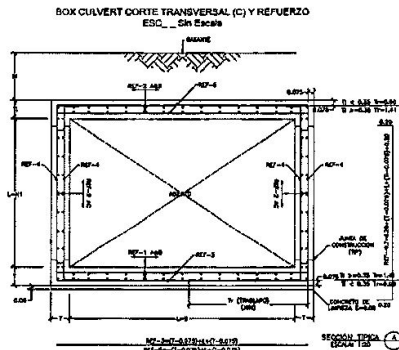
Sección transversal de los detalles a realizar. Fuente: Planos entregados por el Solicitante.
